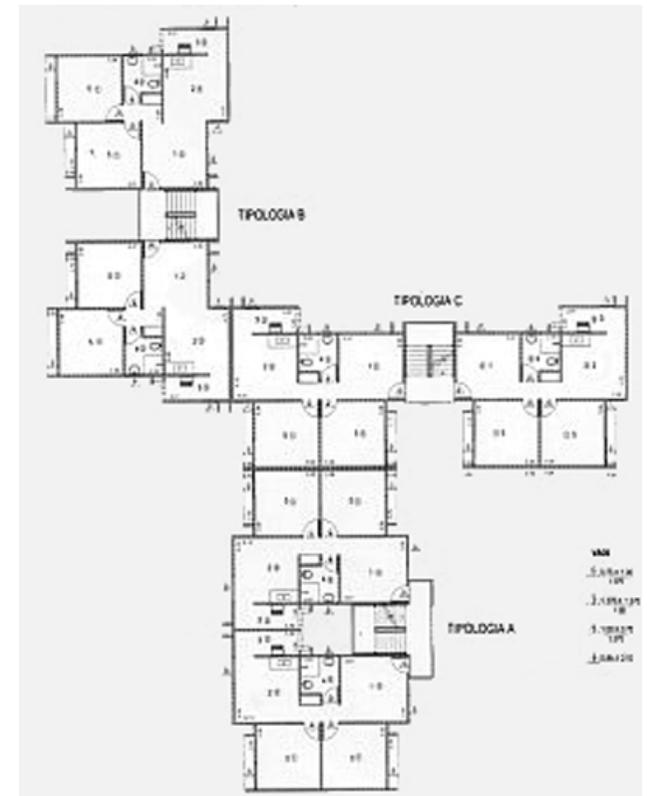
Tipologia planta baixa, Conj. União da Juta.
